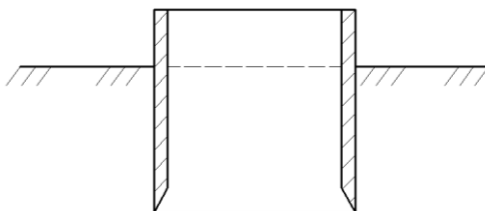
Металлический цилиндр (режущее кольцо)
